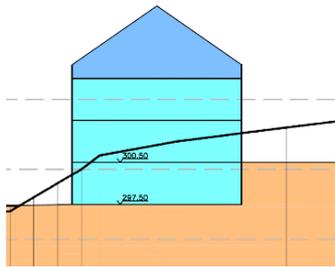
Schnitt einer Reihenhausbebauung mit Satteldach
